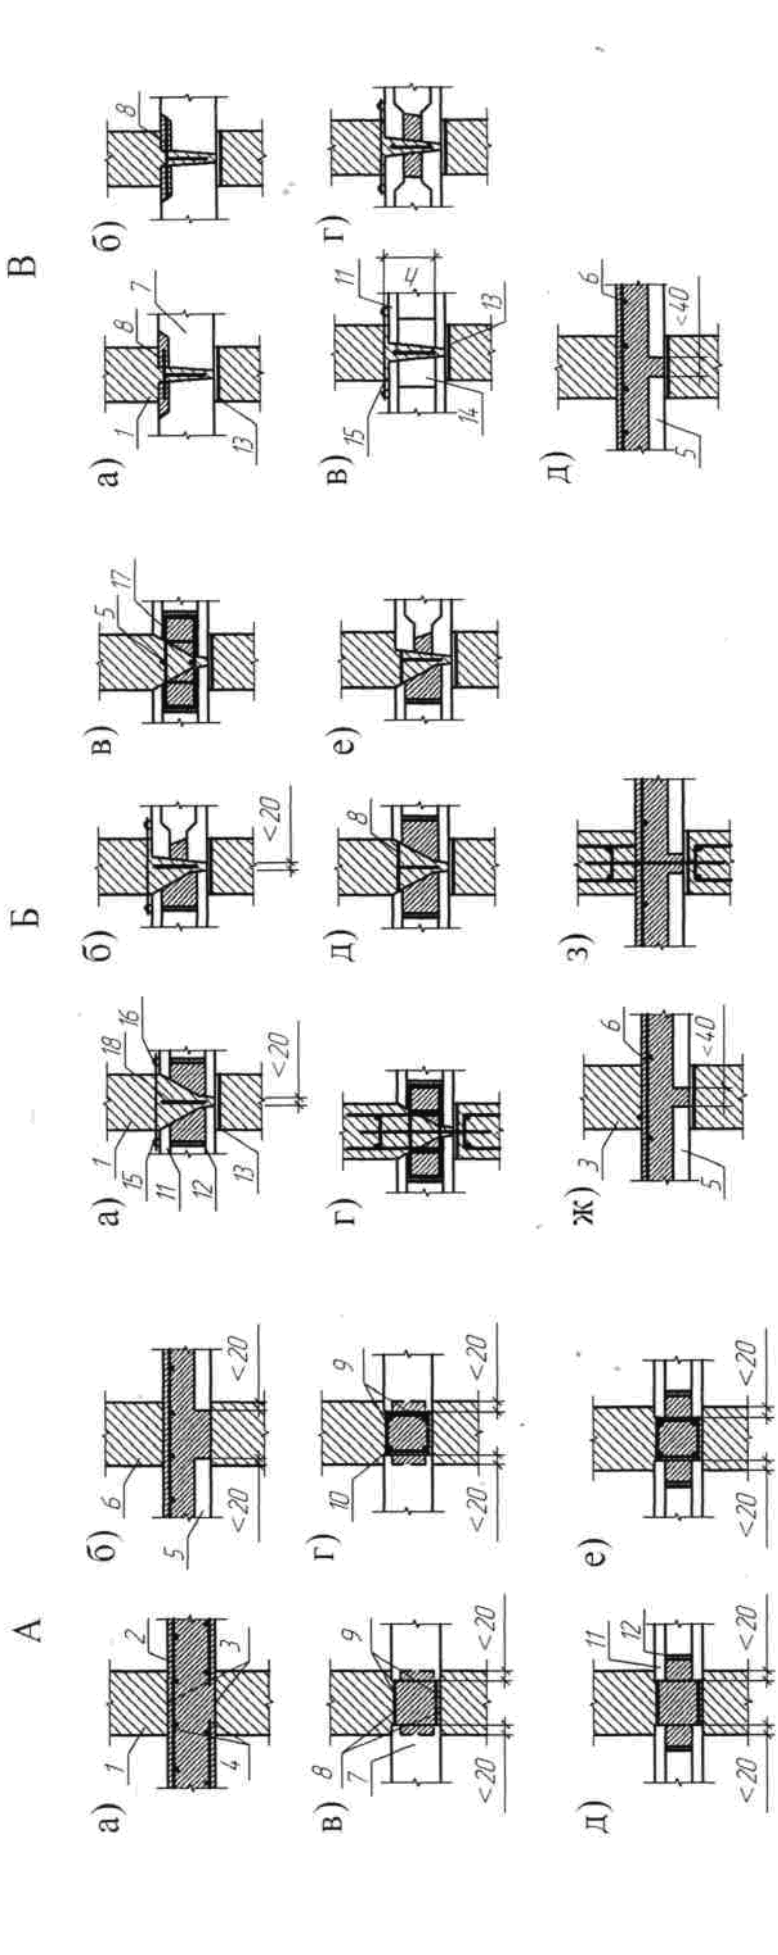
Сопряжения внутренних монолитных стен с перекрытиями.
